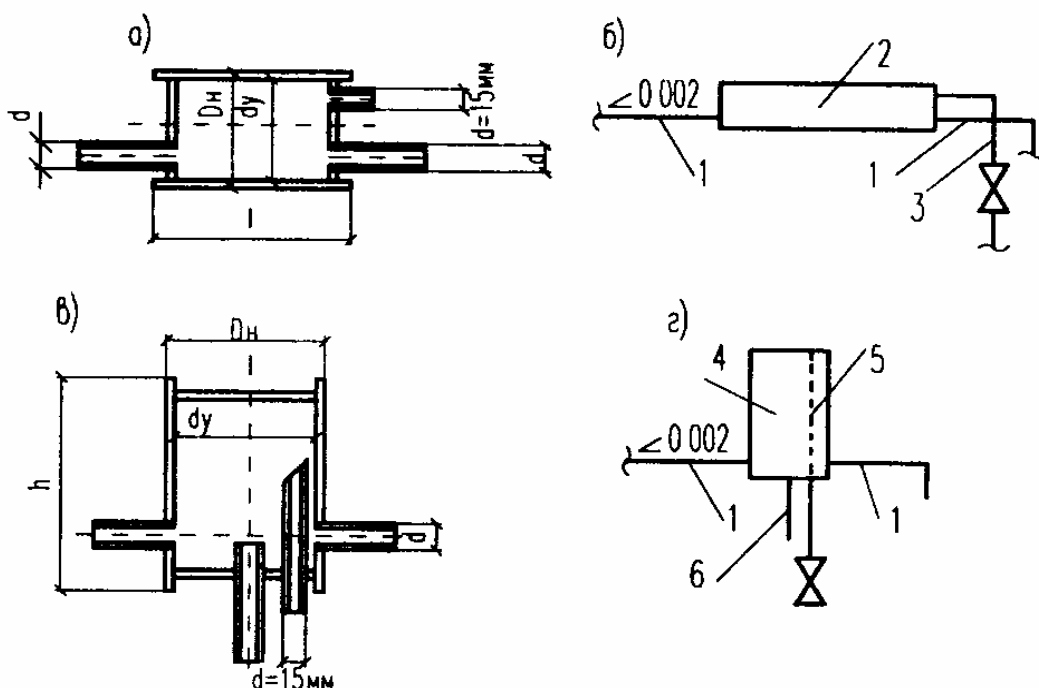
Проточные воздухоборники: а – горизонтальный; б – схема присоединения; в – вертикальный; г – схема присоединения; 1 – подающая магистраль; 2 – горизонтальный воздухоборник; 3 – труба для выпуска воздуха; 4 – вертикальный воздухоборник; 5 – воздушная трубка; 6 – главный стояк
